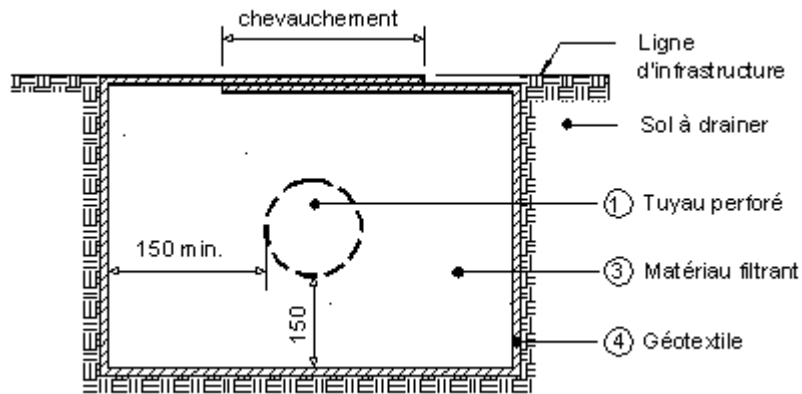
Drainage par tuyau perforé et drain de pierre
